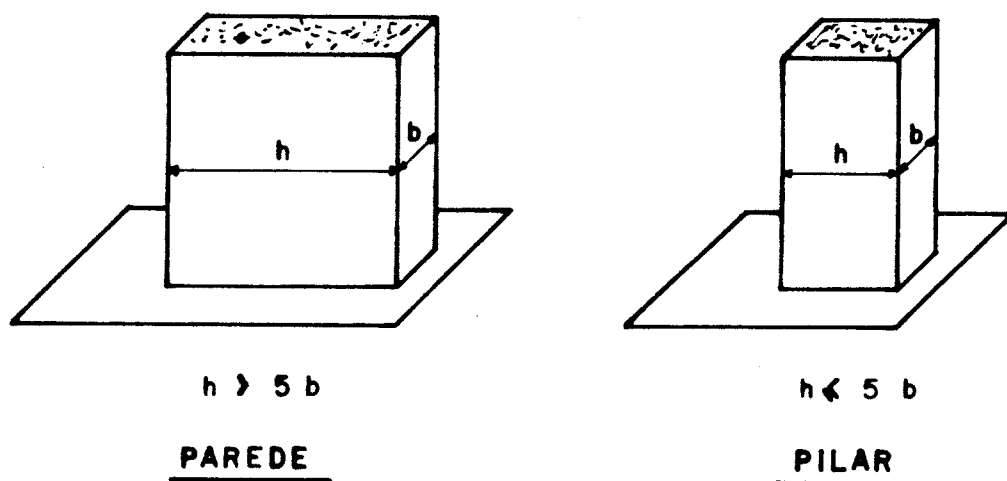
Distinção entre paredes e pilares⁽¹⁵⁾.
